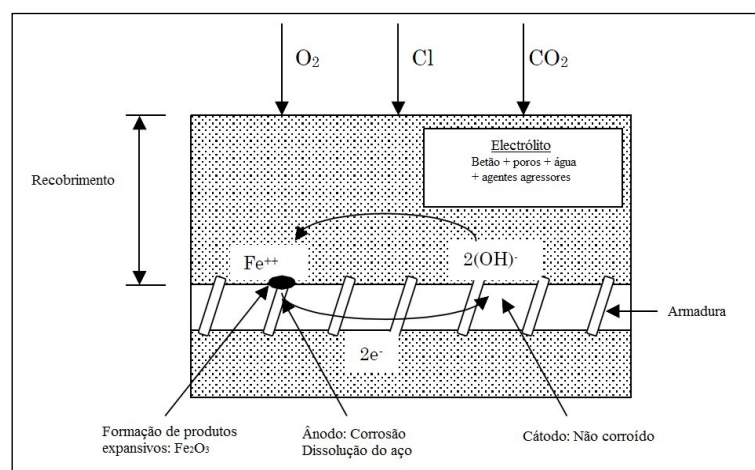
Mecanismo de corrosão de armaduras em betão armado (adaptado de Andrade, 2001).
